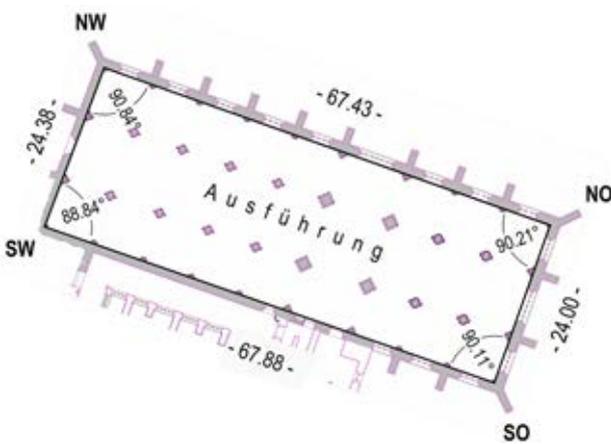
Münster Neuberg, das Grundrechteck (inneres Rechteck) der Planung wird durch die Ausführung zu einem beliebigen Viereck, dessen Geometrie aus Plan Abb. 6 (oben) mittels CAD im metrischen System graphisch erfasst wurden.
